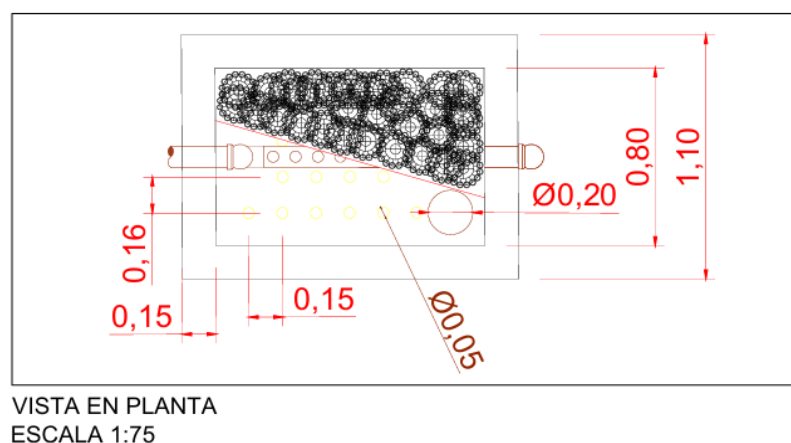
Vista en Planta de FAFA. Escala 1:75.
